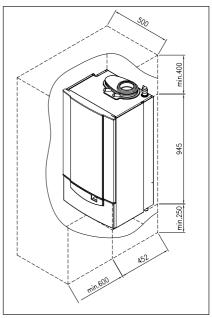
Platzbedarf für Montage 05.W4H.79.00026
